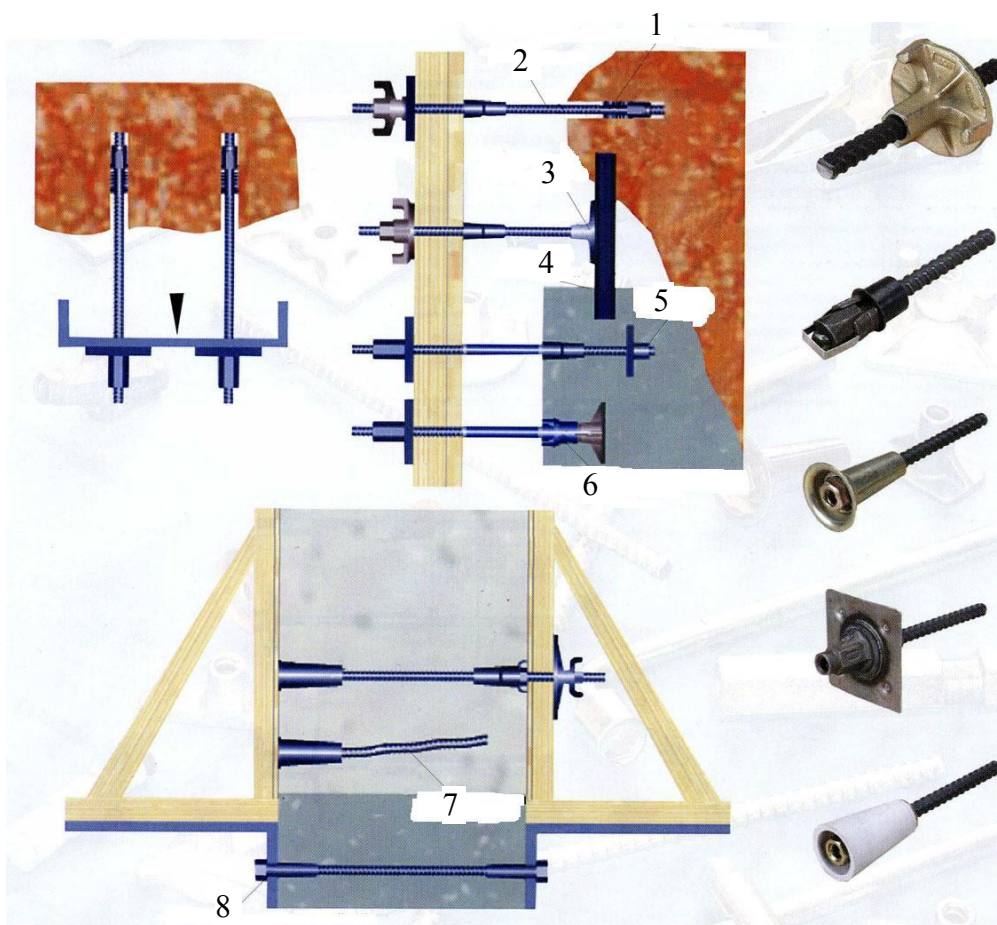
Кріплення опалубки: 1 – дво- (три-) пелюстковий анкер; 2 – стяжка-болт; 3 – гайка-фланець приварна; 4 – сталева конструкція; 5 – закладна плата; 6 – закладний анкер; 7 – хвилеподібна стяжка; 8 – фіксуючий конус з гайкою
